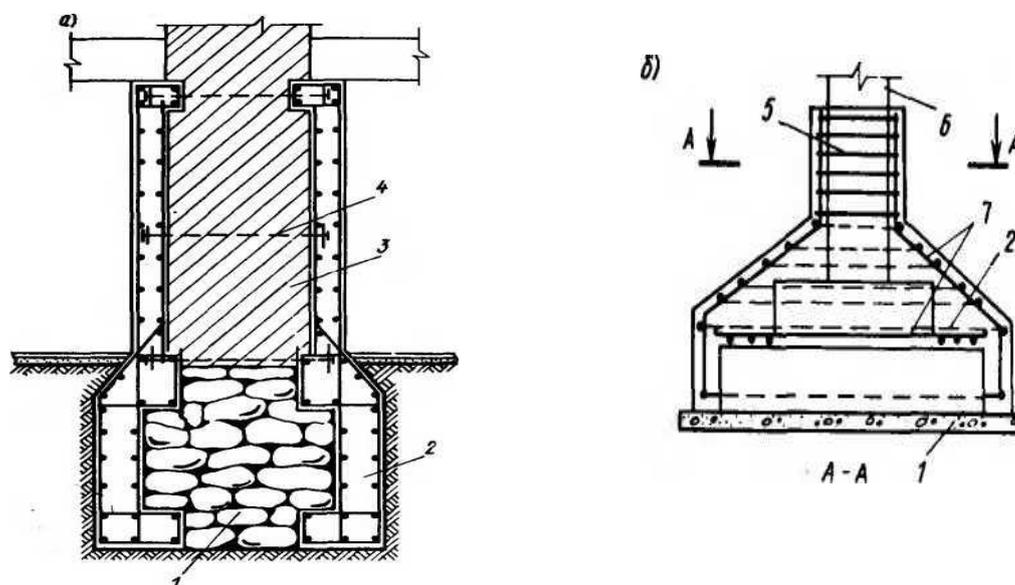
Схема укрепления ленточного а) и столбчатого б) фундаментов железобетонной обоймой:
